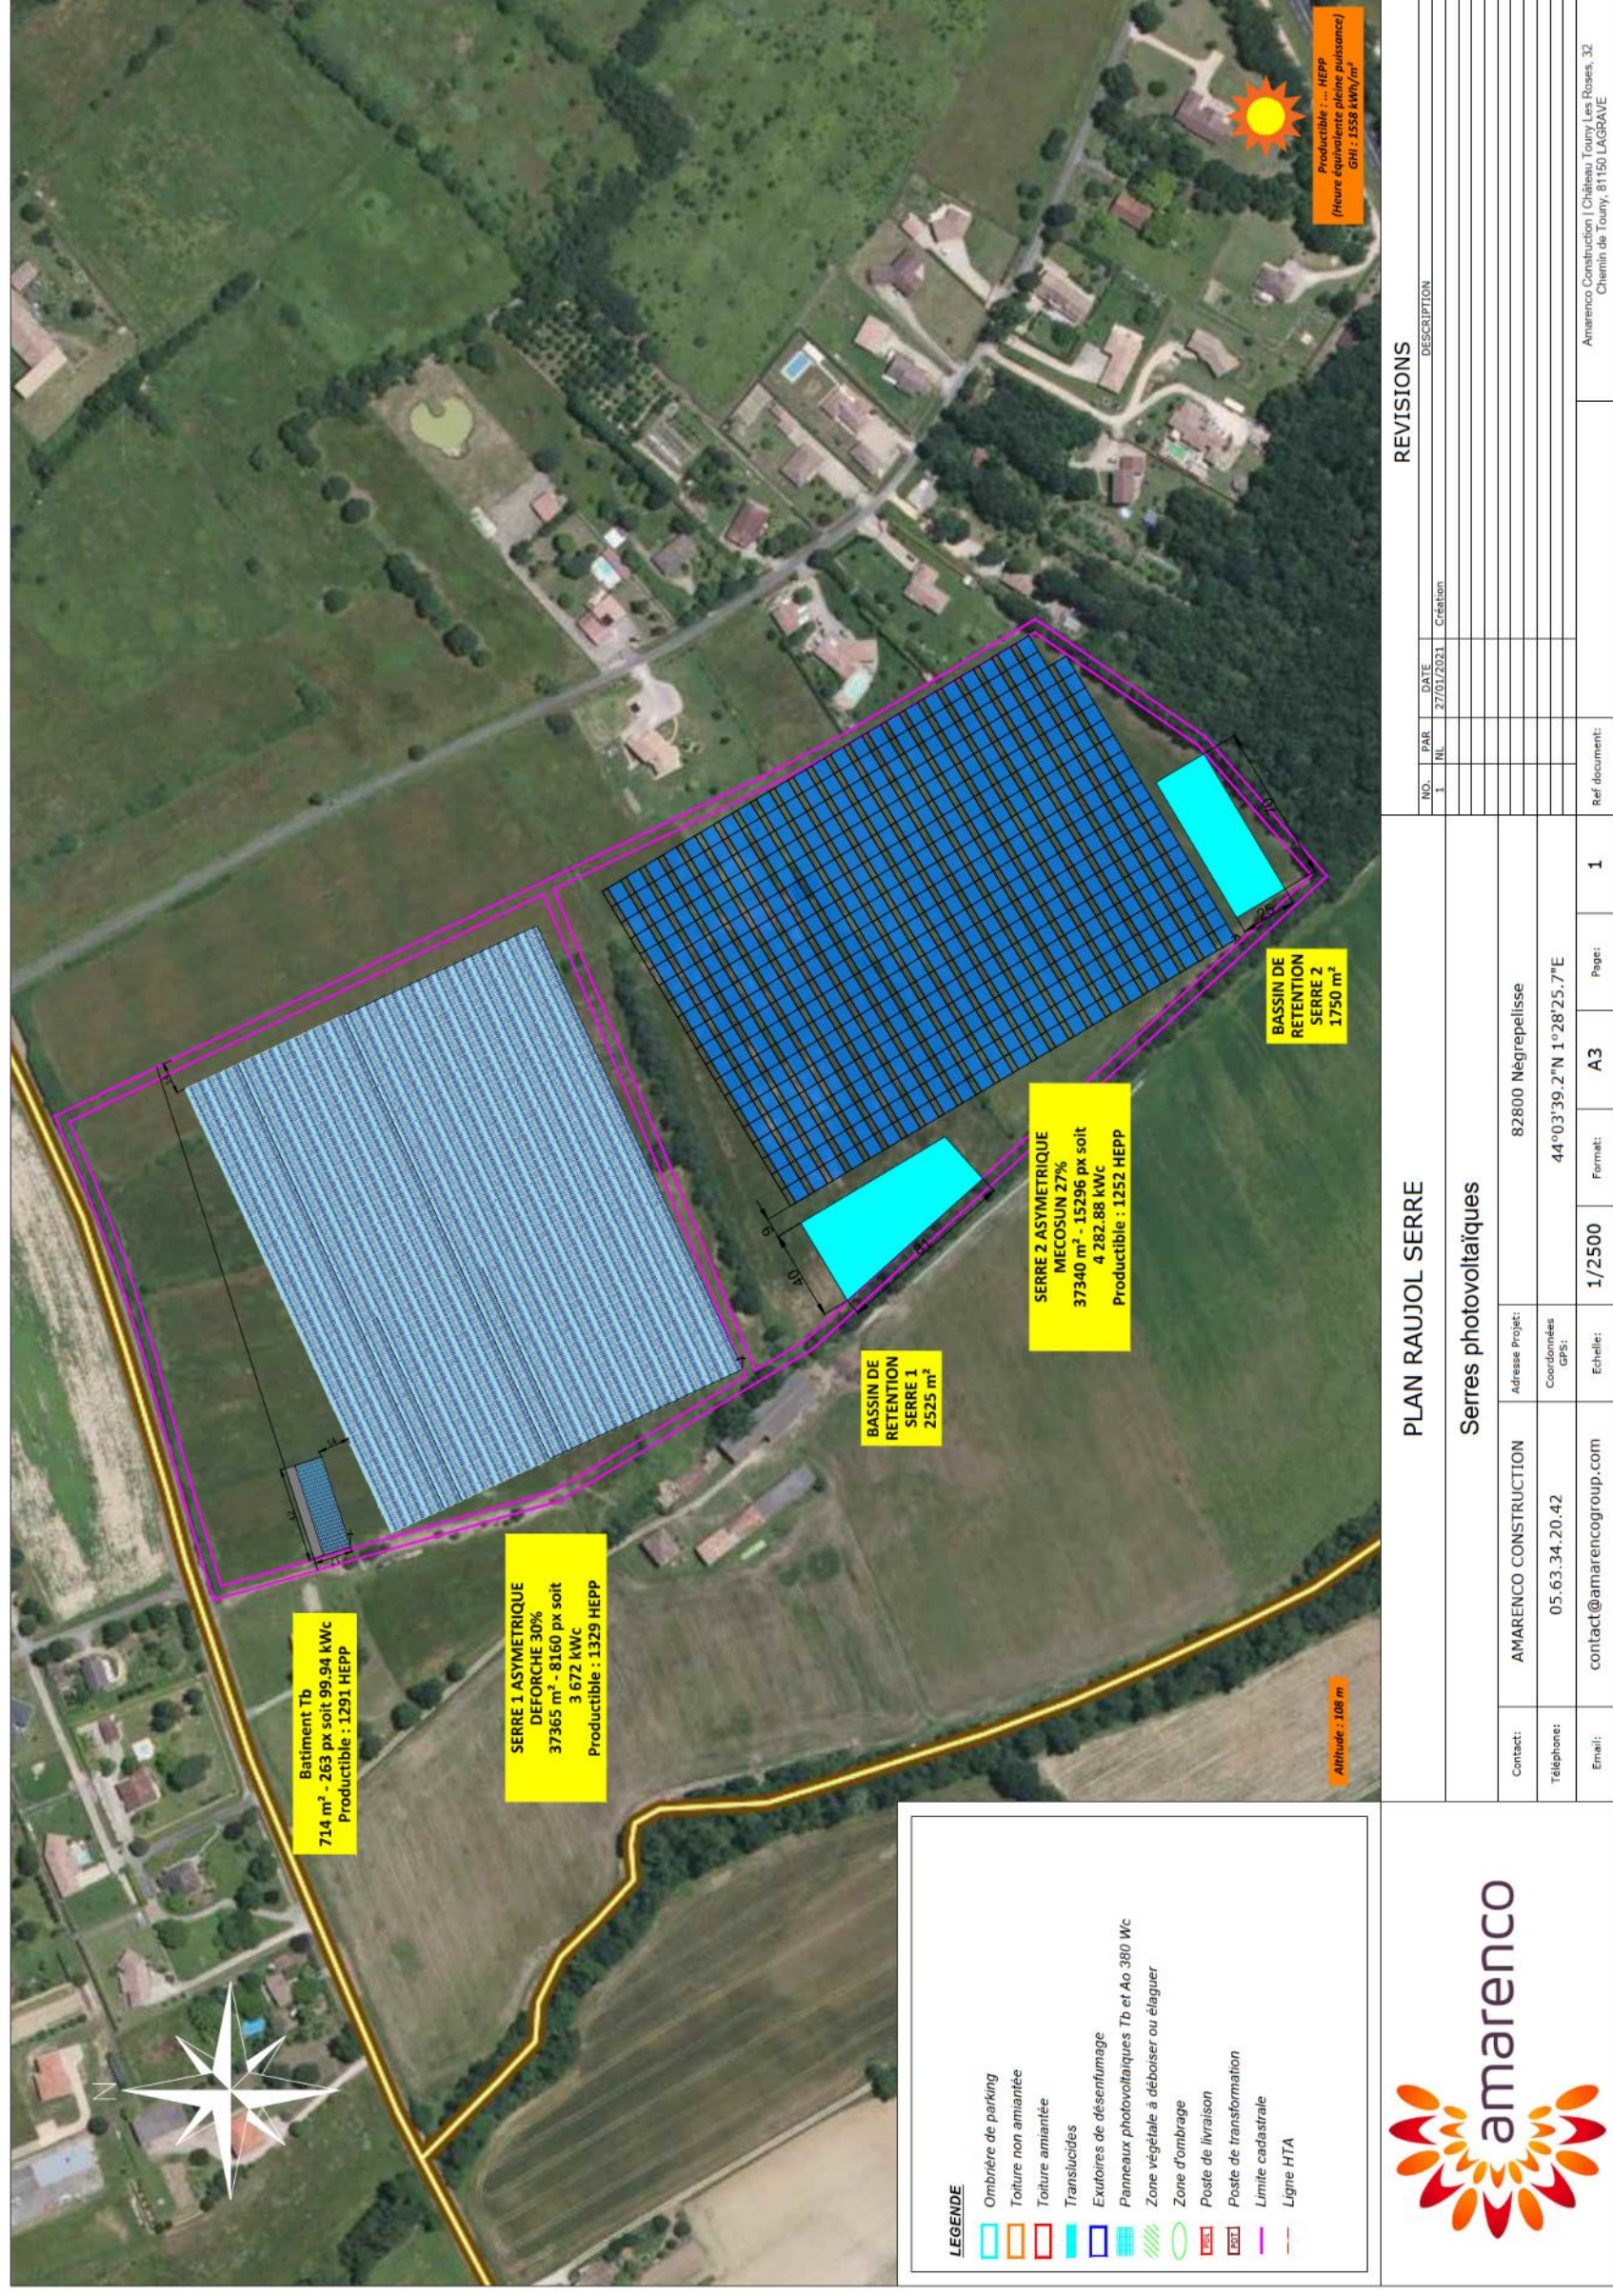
Plan d'implantation de la variante 1 - source : Amarenco
